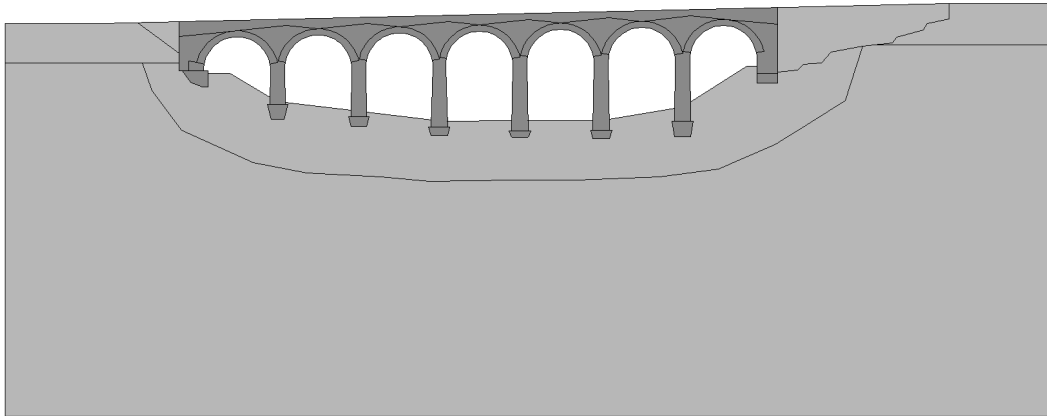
Geometrisches Modell einer siebenfeldrigen Mauerwerksgewölbebrücke für den Abgleich mit Überfahrtsmessungen
